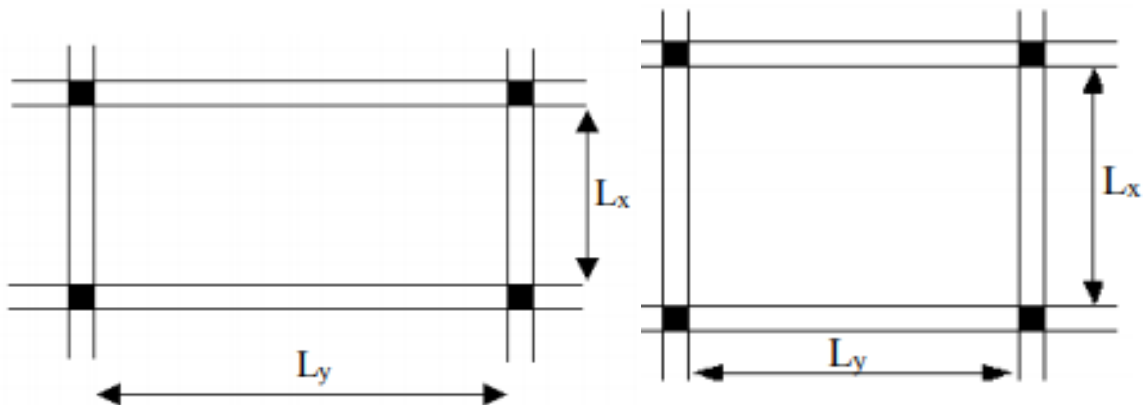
Dimensions d'un panneau de dalle pleine
